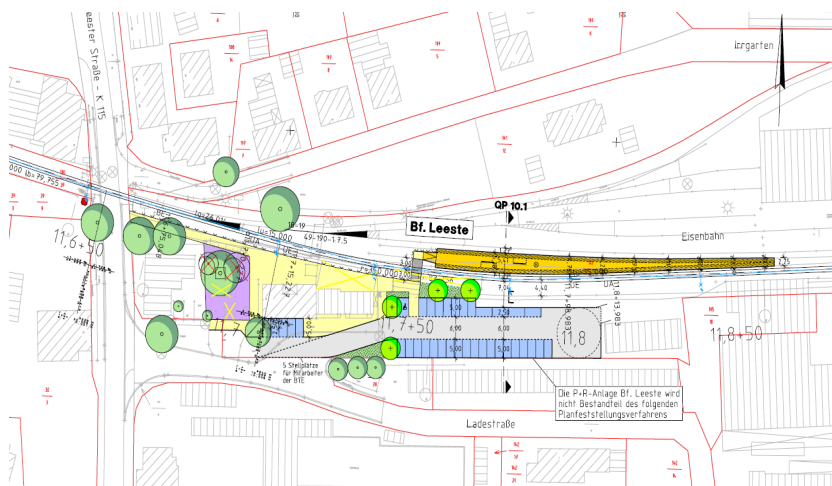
Verlängerung Linie 8 - Lageplan Nr. 11, Bahnhof Leeste - Var. 1 (Entwurfsplanung) (Q: BTE 2008)
